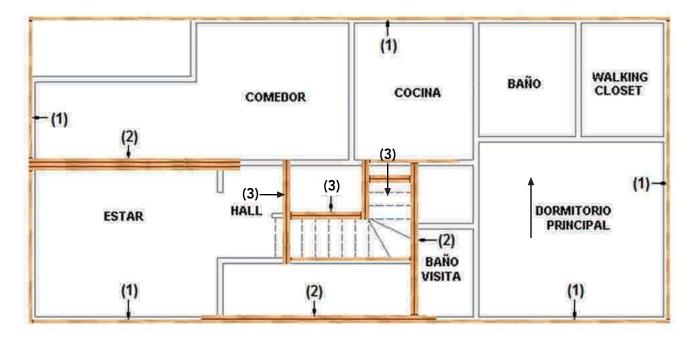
31: Plano planta de vigas perimetrales (friso) (1), viga compuesta (2), necesarias según cálculo para reforzar al envigado por distanciamiento de los apoyos y viga cabezal (3) como refuerzo en el perímetro de la escotilla de la escalera.
